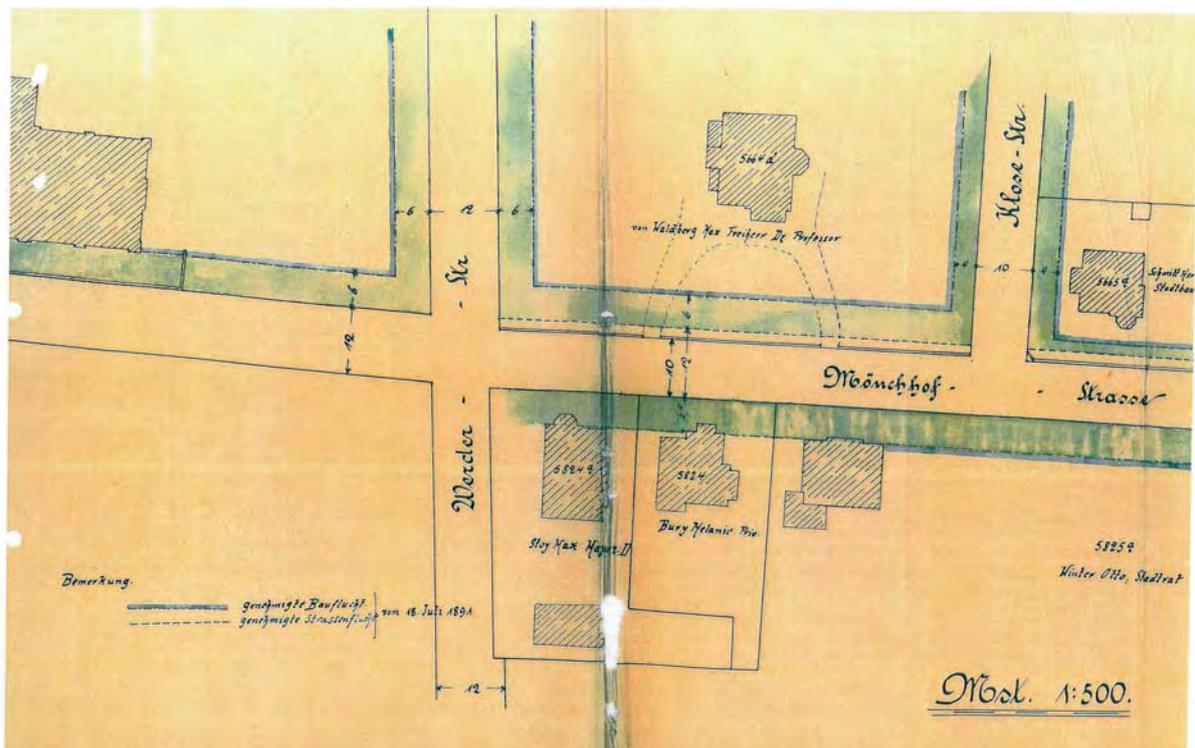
Ausschnitt Baufluchtenplan Bereich Mönchhofstraße 12
